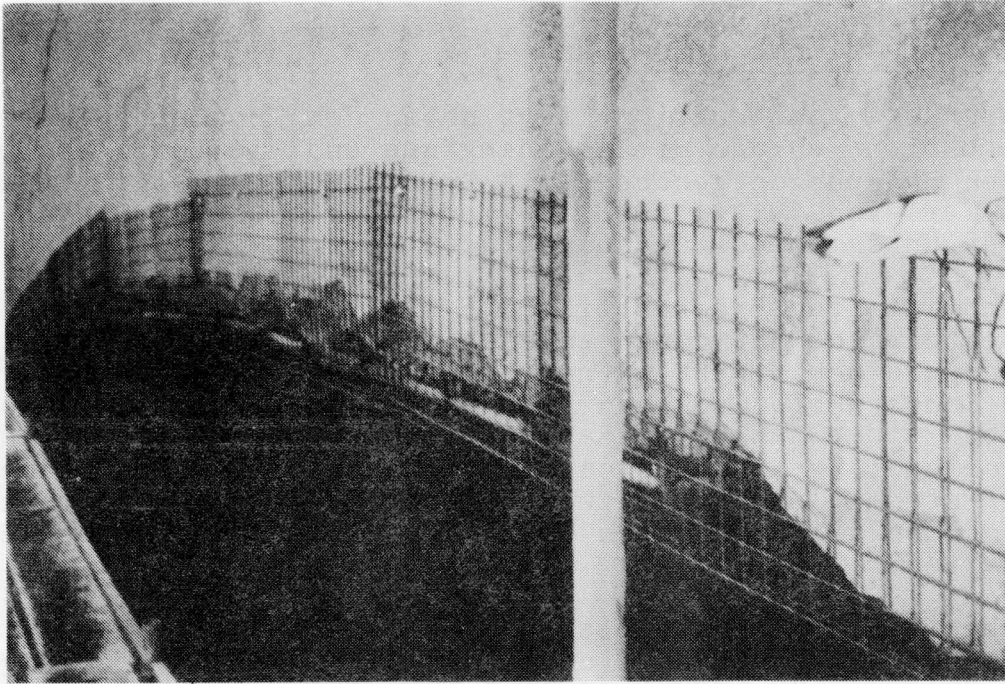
Instandsetzung der Betonaußenflächen im Flutbogenbereich
